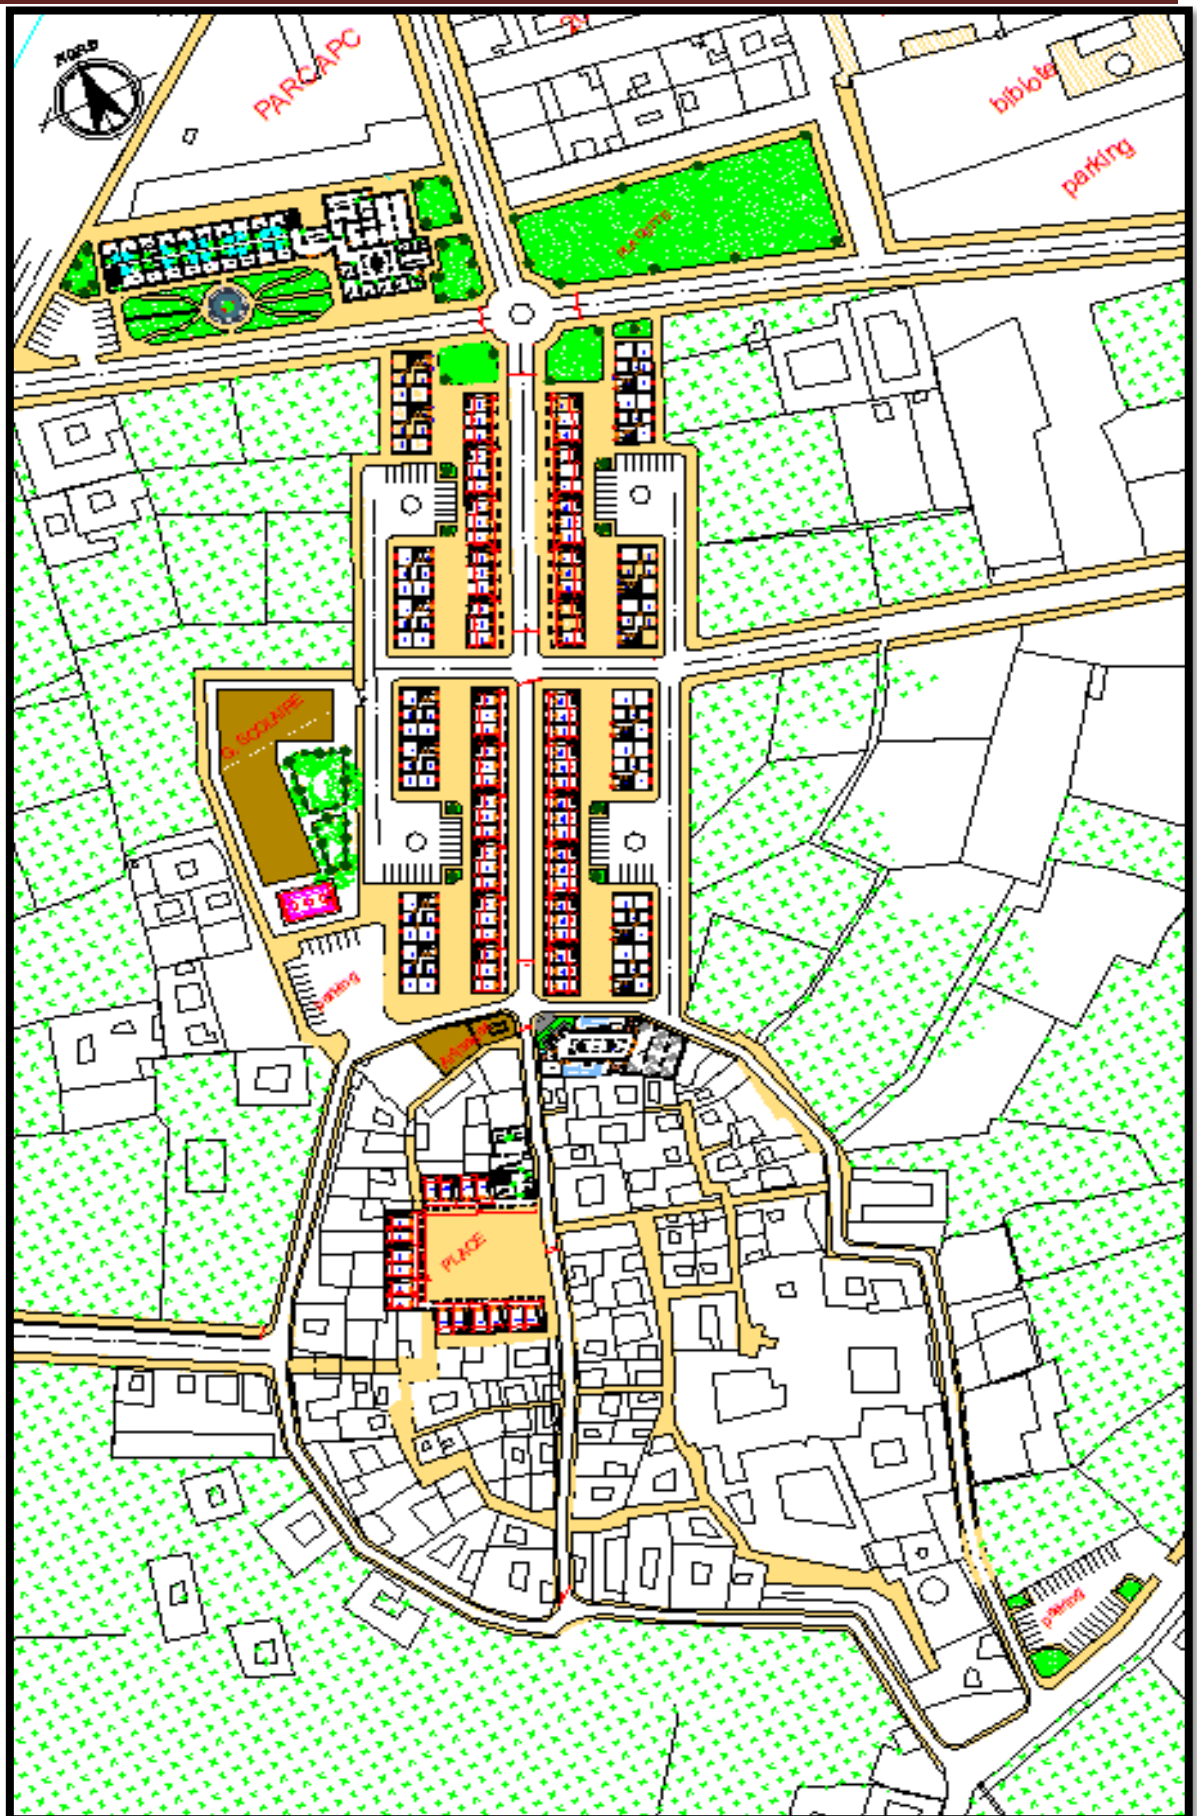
Plan d'assemblage (Source : par l'auteur)
